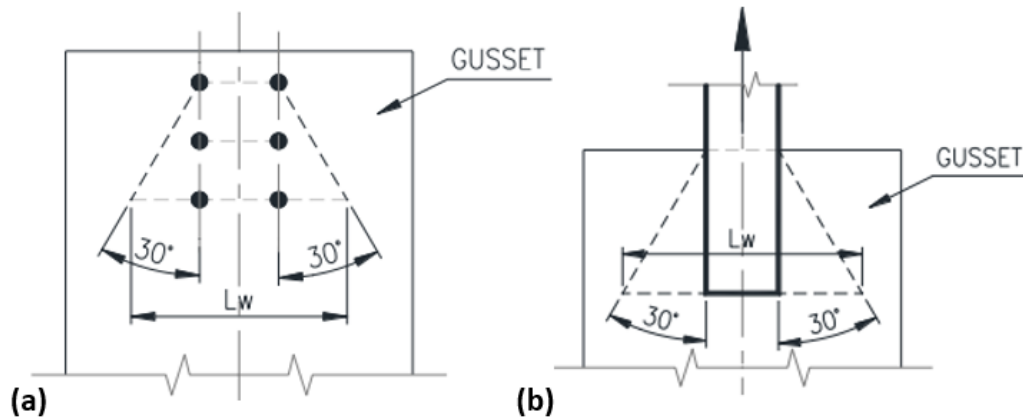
Sección de Whitmore: (a) conexión apornada; y (b) conexión soldada [100].
